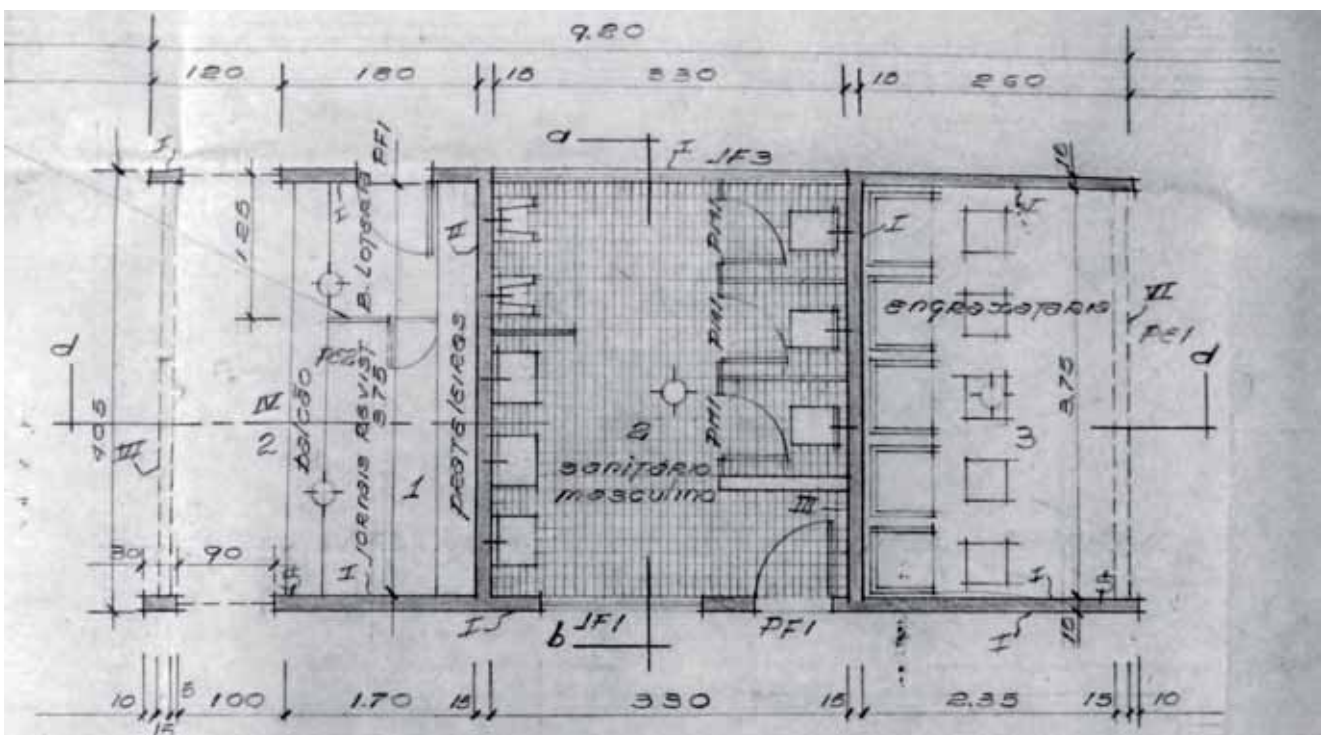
Foto do projeto original de Nauro Esteves - 1964 - planta
